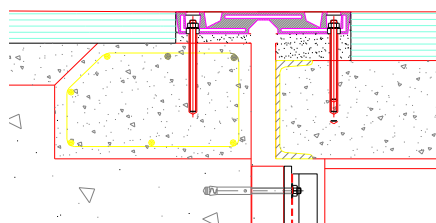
Pormenor da junta de neopreme simples (Fonte: Estradas de Portugal)
